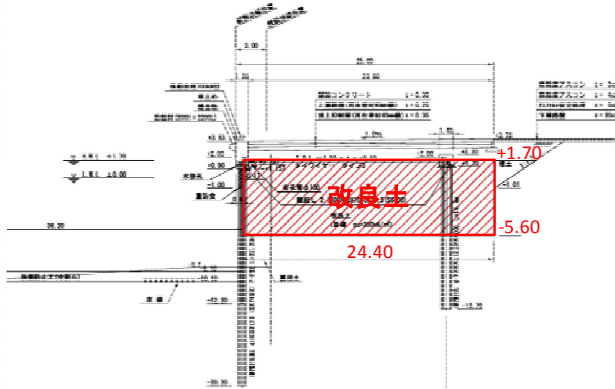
西港区岸壁西-9.0m (耐震) 標準断面図
